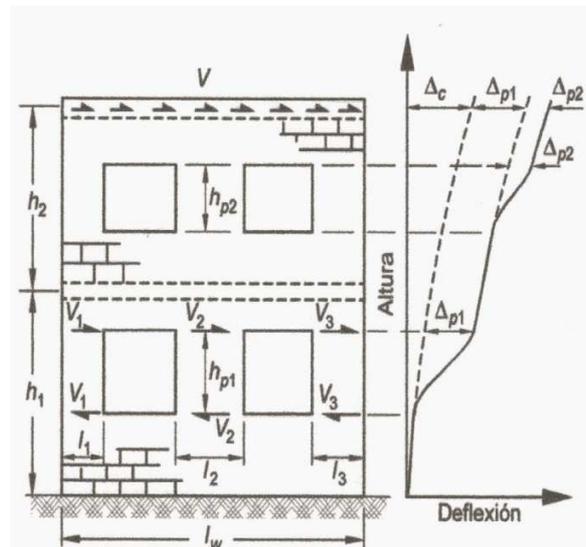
Deformaciones debidas a fuerzas laterales en una estructura de mampostería con aberturas (Paulay y Priestley, 1992).
